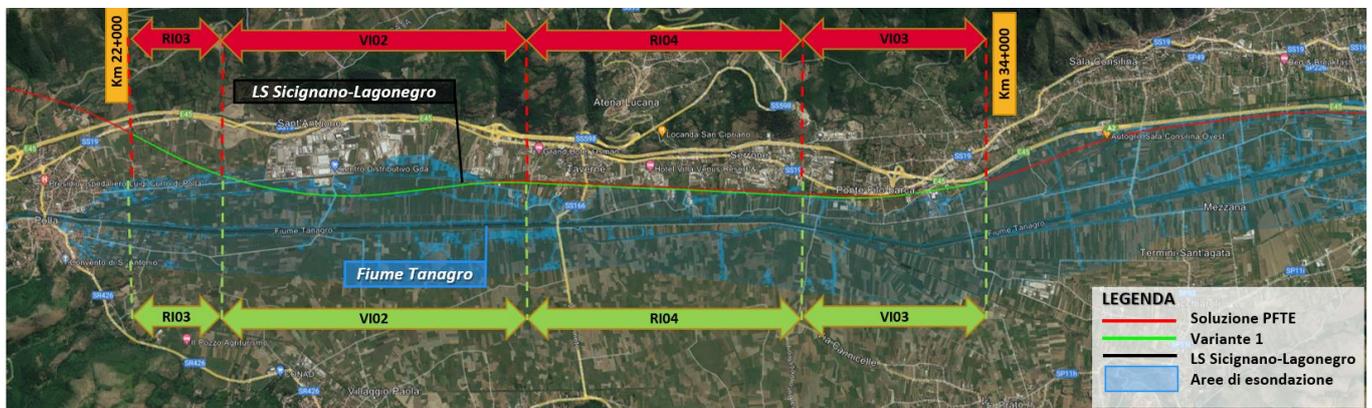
Stralcio planimetrico con confronto soluzione PFTE e variante 1
